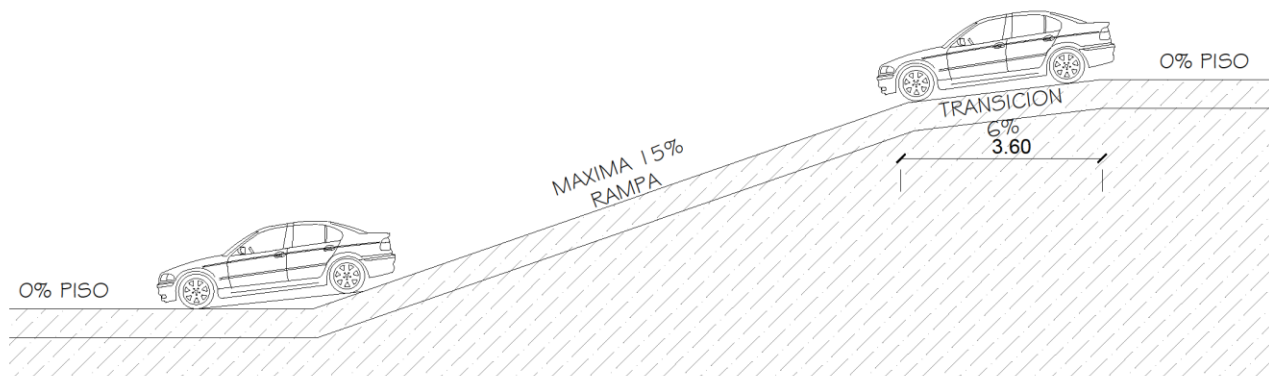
Corte Rampa/Fuente Elaboración Propia
